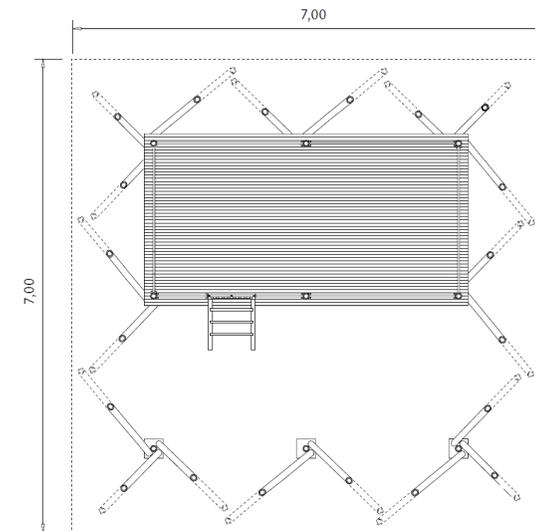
Vista superior (Techo) de la vivienda post-desastres en bambú.
